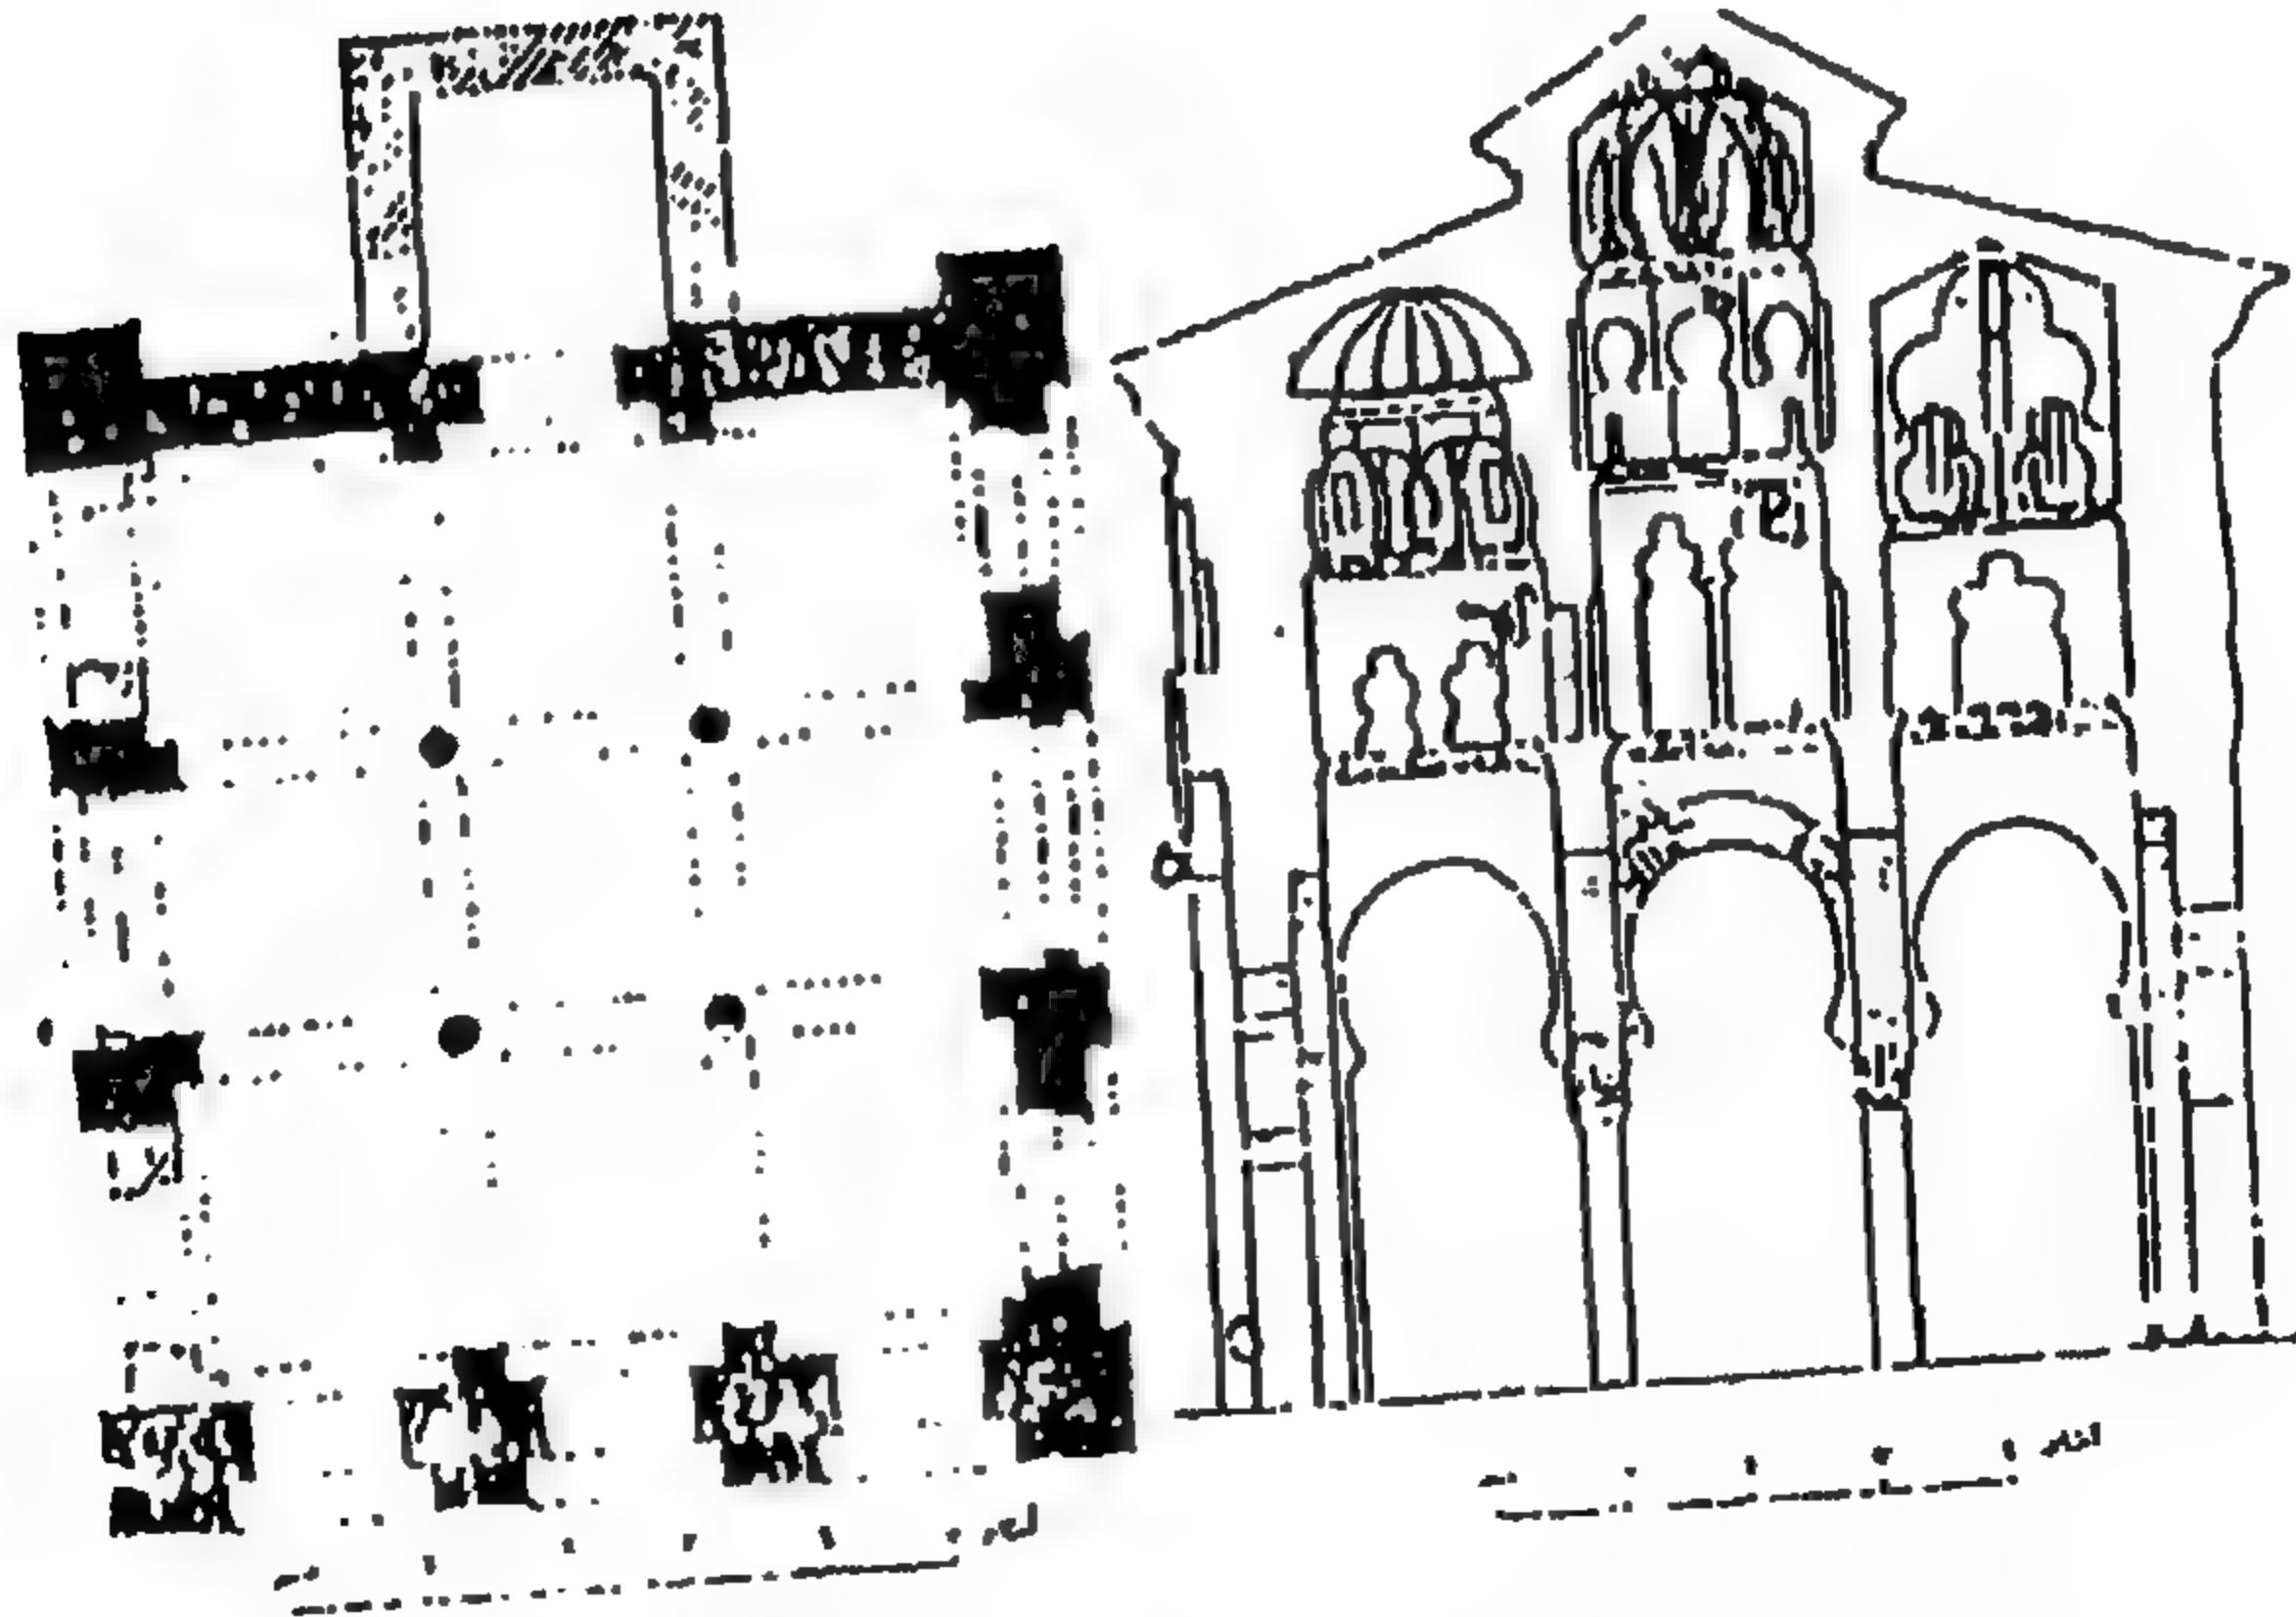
مسقط أفقي لمسجد بوفتاته في سوسه بتونس
